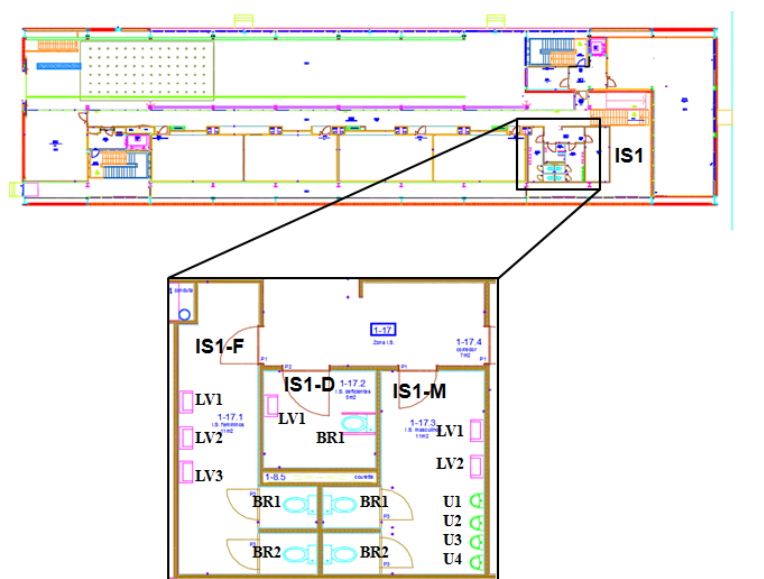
Planta Piso 1 - Localização da Instalação Sanitária IS1e dos respetivos dispositivos de utilização.
